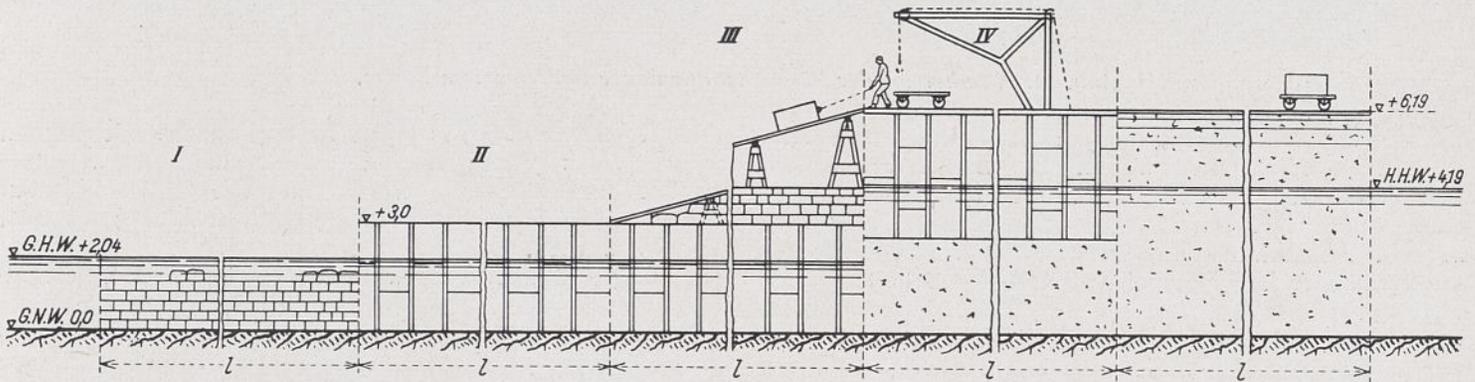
Ansicht des Baugerüsts der Schutzmauer nach Brennecke.
